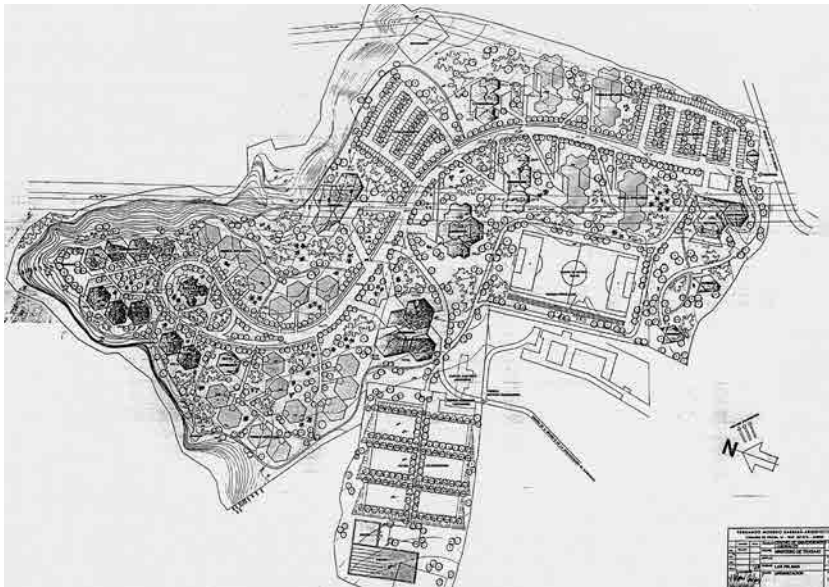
Plano de ordenación general del conjunto según la primera propuesta.
